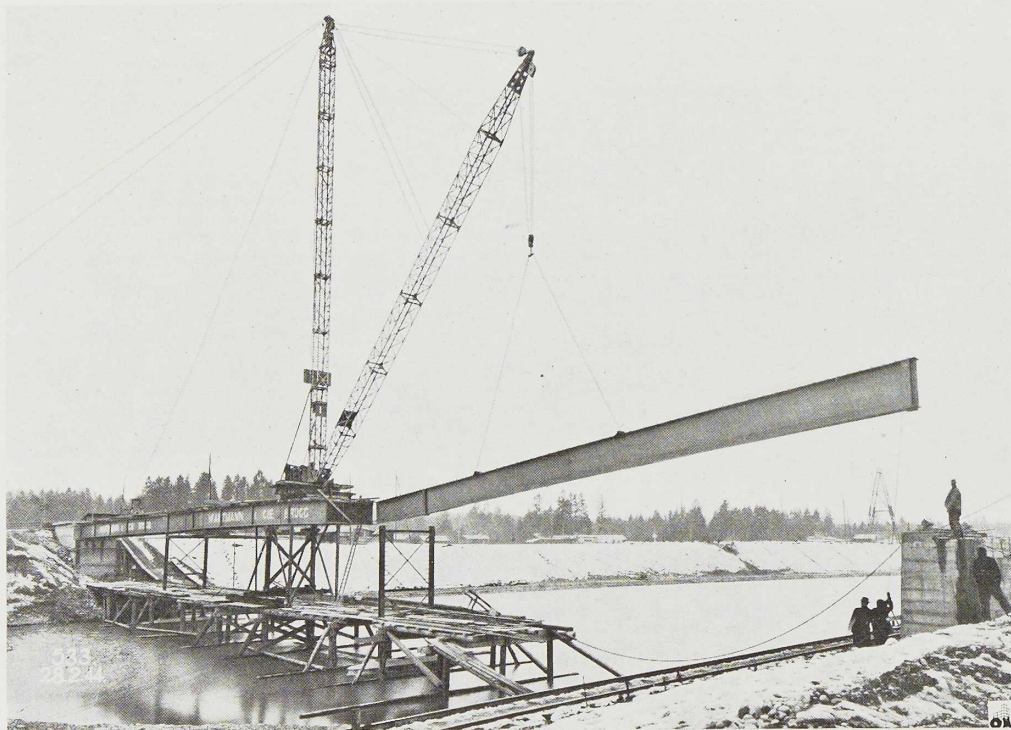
Vue du pont en montage. A l'aide du derrick, on procède à la mise en place d'une poutre de 31<sup>m</sup> 58 de longueur.
